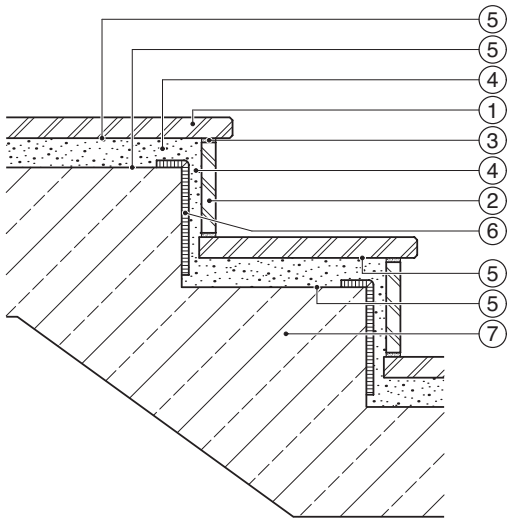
Treppenbeläge im wasserdurchlässigen Mörtelbett
